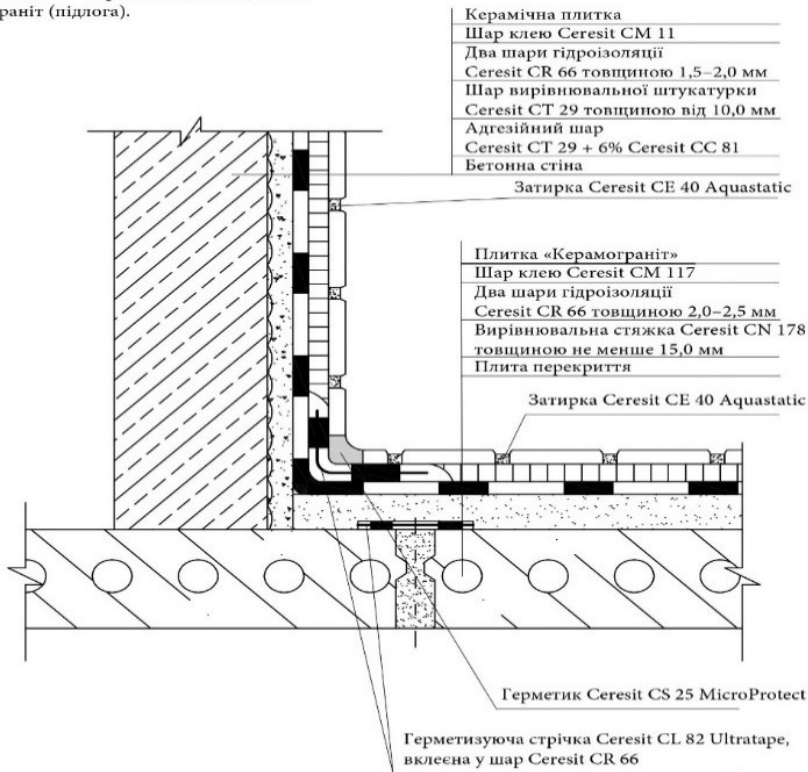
Конструкція системи гідроізоляції для виробничих душових приміщень, розташованих на плитах перекриття.
